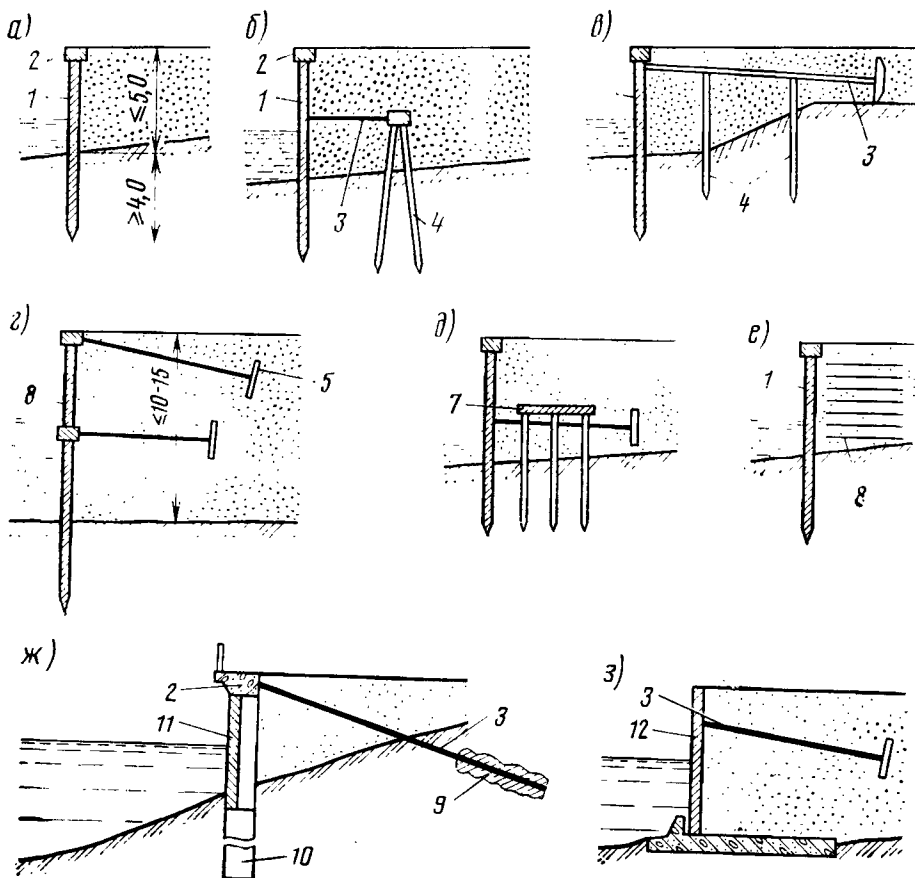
Шпунтовые и заанкеренные подпорные стены:
